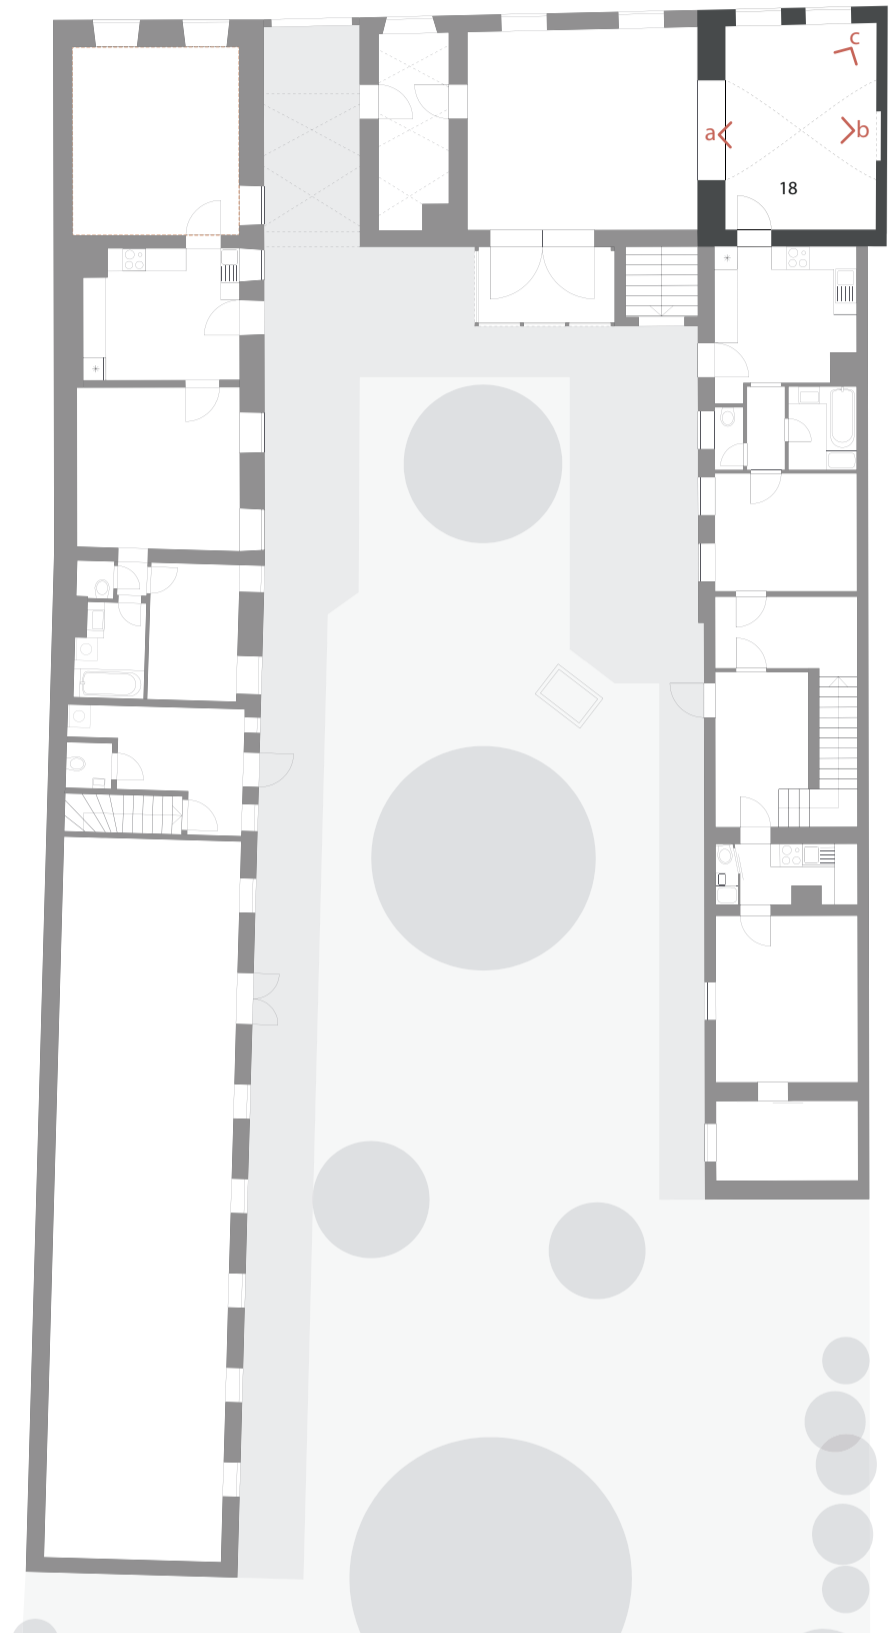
Grundriss Erdgeschoß | M 1:200 | Raum 18
